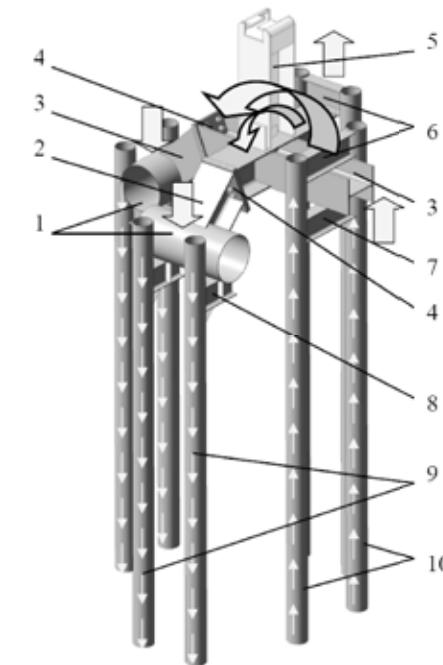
Фрагмент конструкции металлического свайного фундамента:
